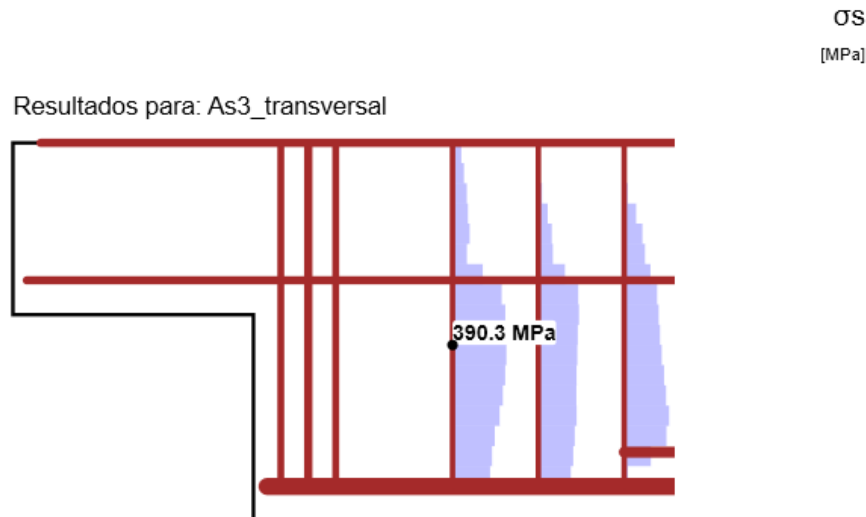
Tensión máxima en primer estribo de refuerzo vertical en DEB-1.7.
